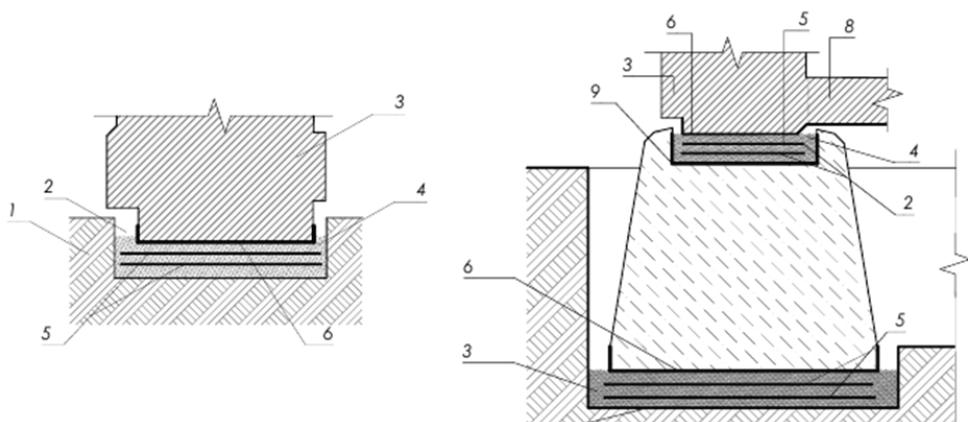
Варианты сейсмозолизации инженера А.Е. Лаврушко: а – скользящий слой между фундаментом и основанием; б – скользящий слой в двух уровнях; 1 – основание; 2 – котлован (траншея); 2 – выемка; 3 – фундамент; 4 – песок; 5 – гладкие или волнистые стальные листы; 6 – стальной лист подошвы фундамента; 7 – обвязка стены; 8 – перекрытие; 9 – стальной желоб
